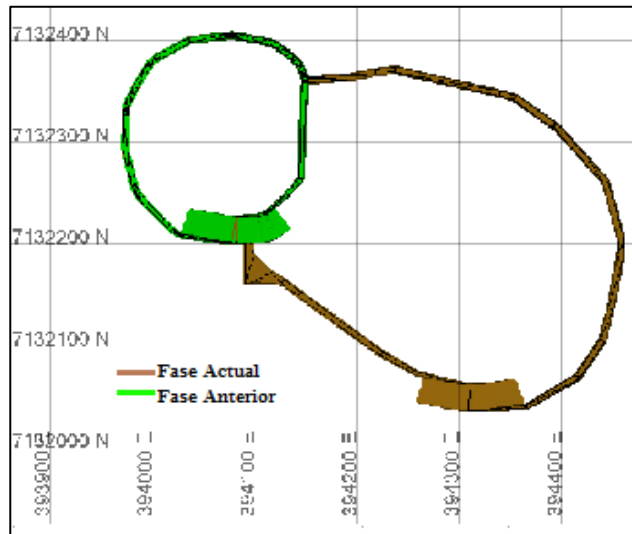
LG2Y Fase 2 - Vista en planta - Banco 1070
